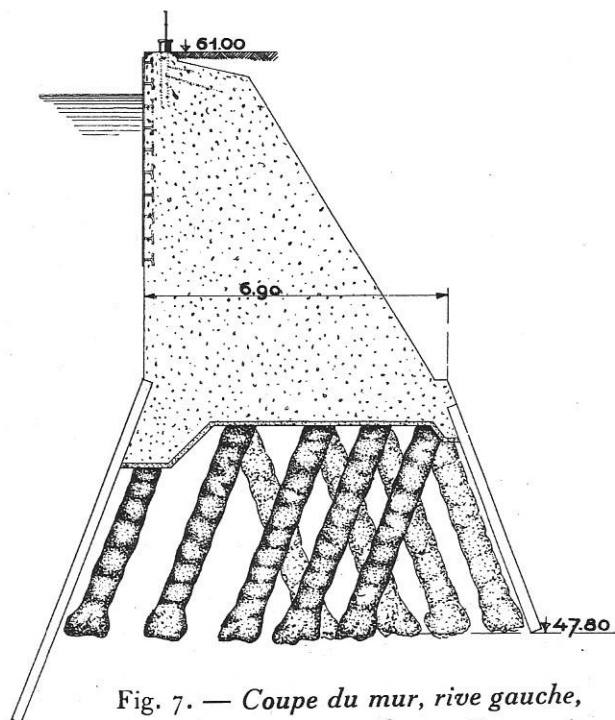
Coupe du mur, rive gauche, constituant mur de soutènement.
